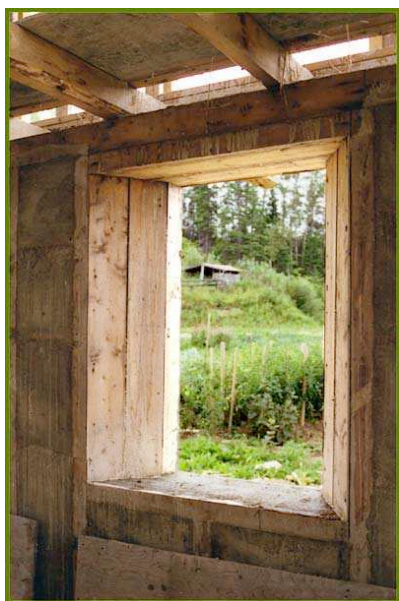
Là encore, on voit le haut du faux cadre d'une fenêtre sud, l'assemblage des « poteaux » (2x4 et 2x8), ainsi que l'installation des sablières linteaux sur ces « poteaux ».
